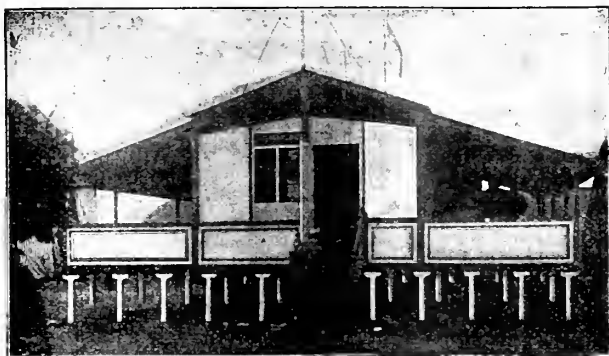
Poteaux de soutènement pour plancher surélevé.
